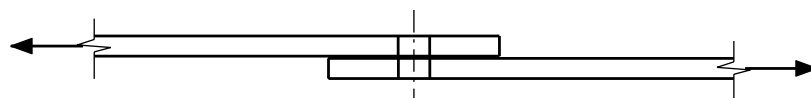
Обычное нахлесточное соединение с одним рядом болтов
